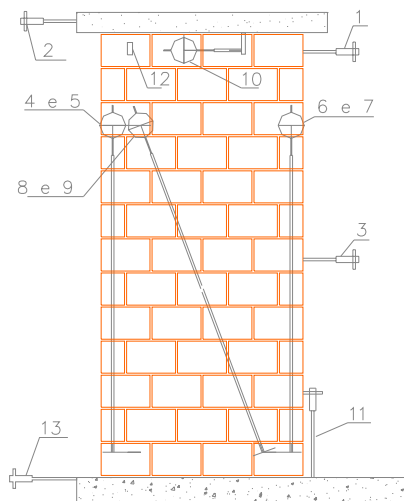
Disposição da instrumentação dos painéis da 1ª configuração de ensaio.
